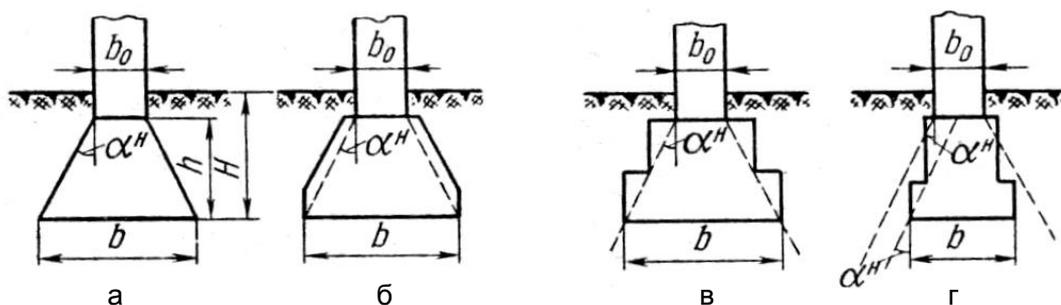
Теоретическая и конструктивная формы жестких фундаментов: а –
